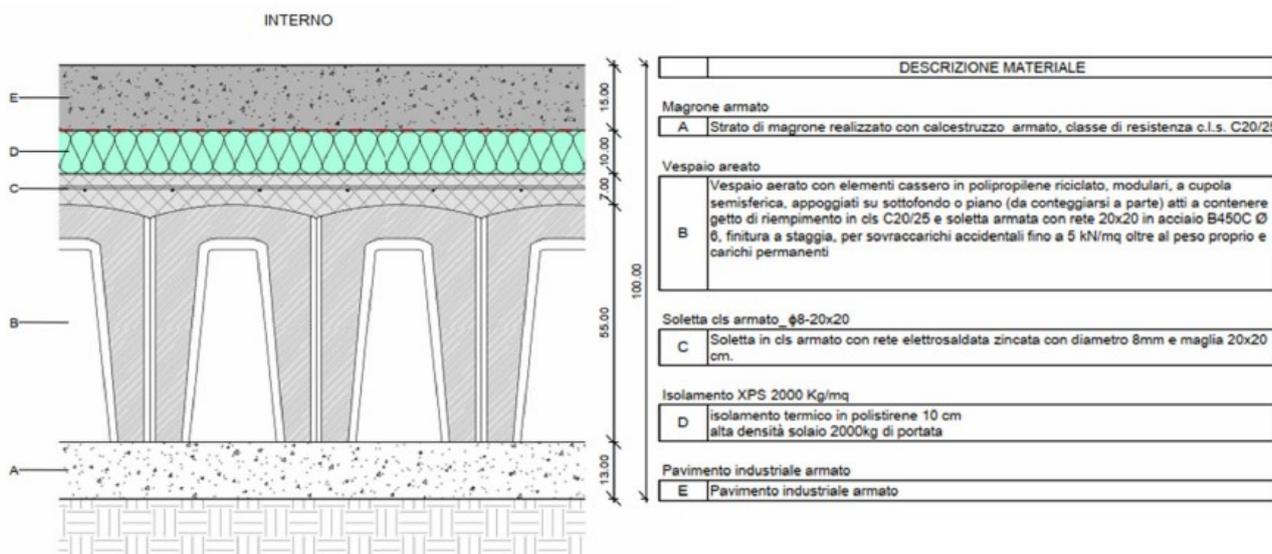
stratigrafia della pavimentazione e dettaglio del vespaio aerato
